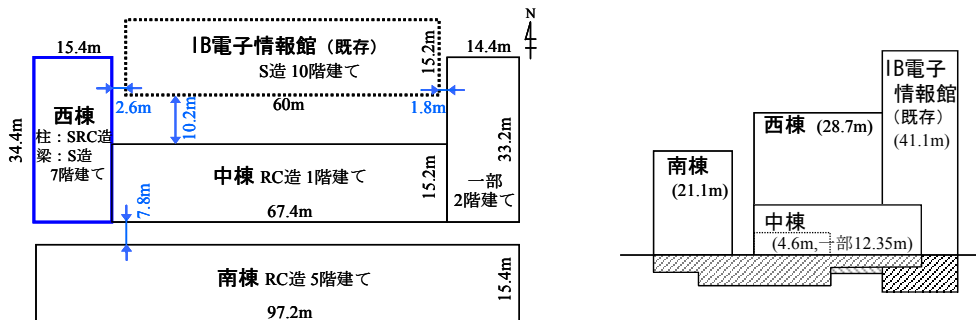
増築後の S 造建物の平面図（左）と東立面図（右）
